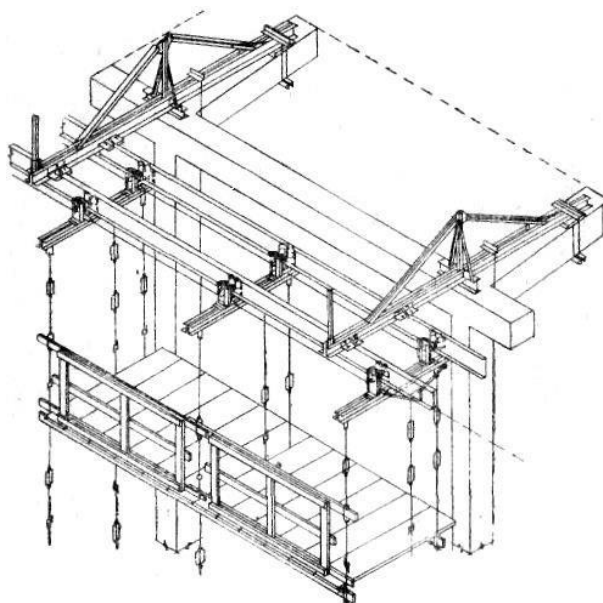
Катучі підвісні струнні риштування прикріплені до залізобетонного каркасу будівлі
